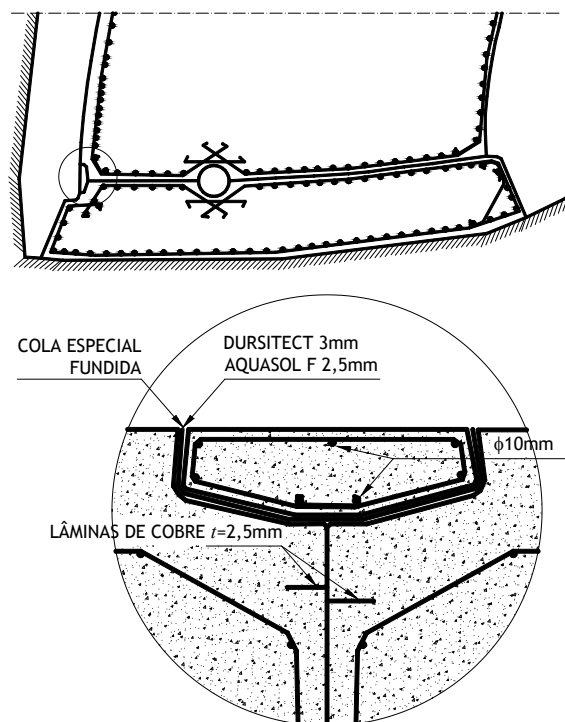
(a) e (b) - Vista em corte (esquemática) de um perfil da barragem de Lumiei com junta perimetral (a) e pormenor (esquemático) dos dispositivos de estanquidade (b) (adaptado de [28] e [12]).
